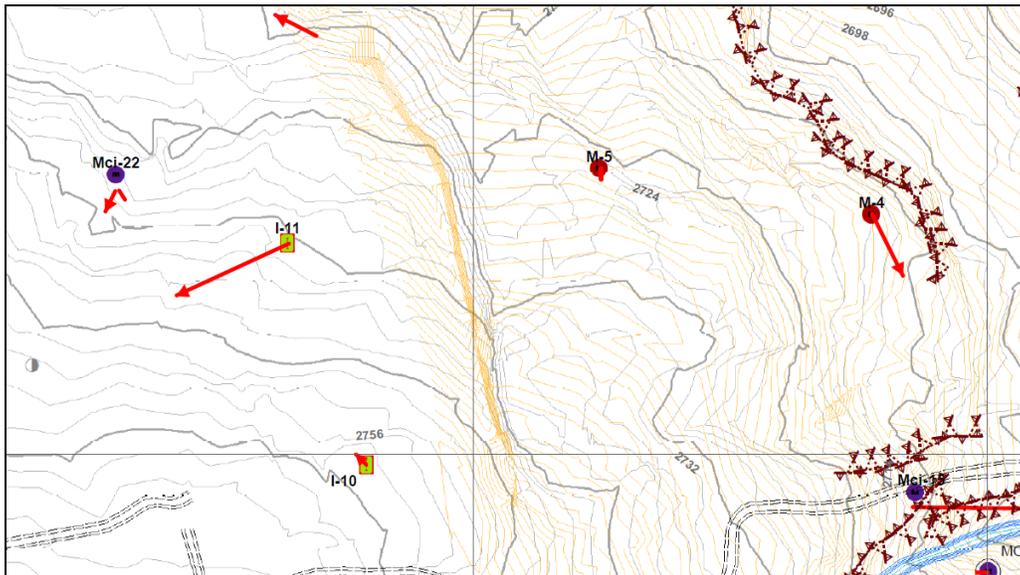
4. Zona 3: Construcción del muro de contención - Sector El Espino I
